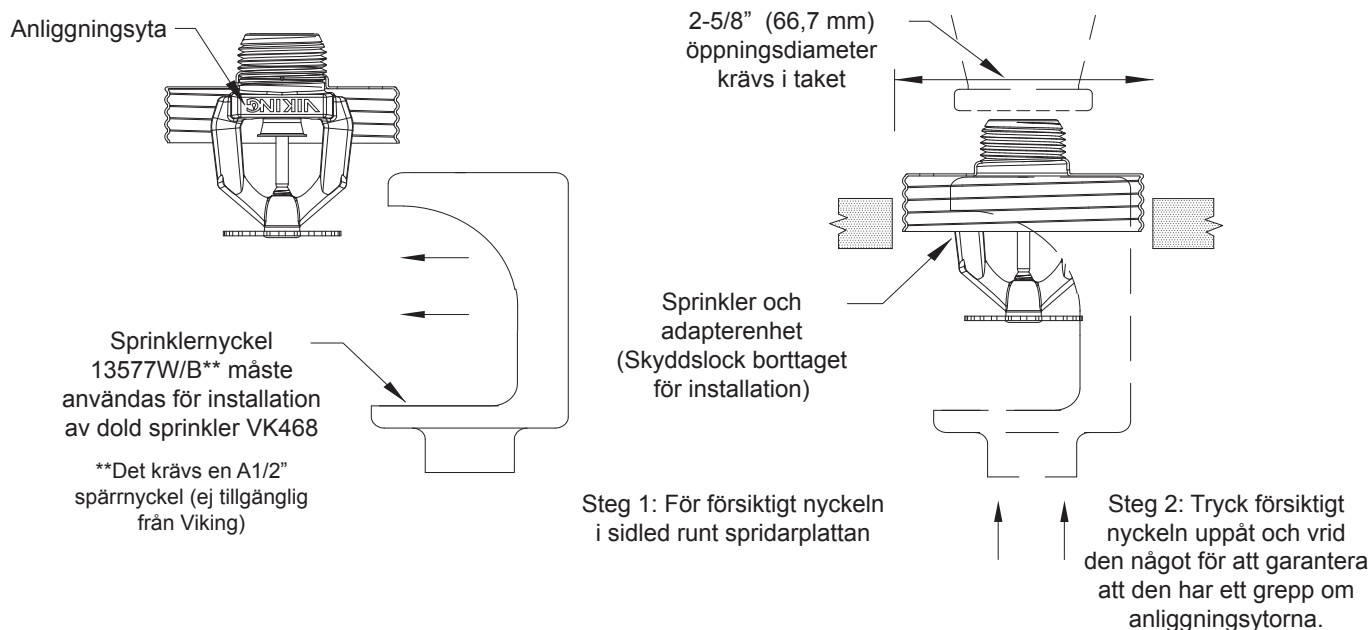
Installation av sprinkler och korrekt användning av sprinklernyckel
